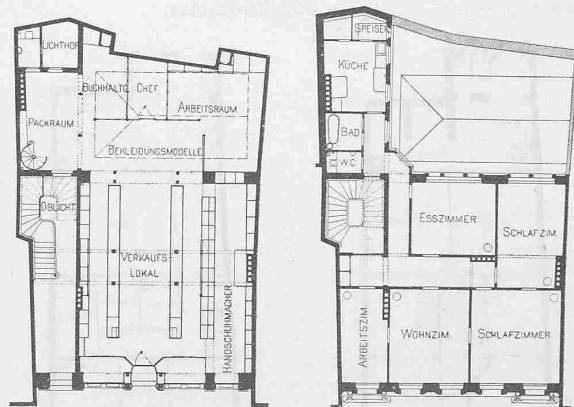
Geschäfts- und Wohnhaus, Freie Strasse Nr. 71. Grundrisse vom Erdgeschoss und II. Stock. — 1:400.
